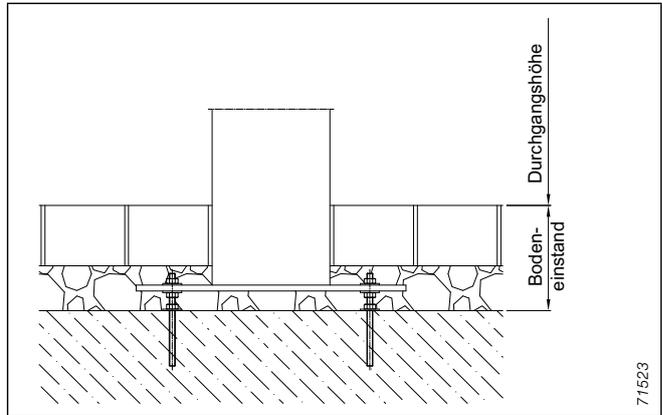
Befestigung auf Betonfundament (mit Distanz)
